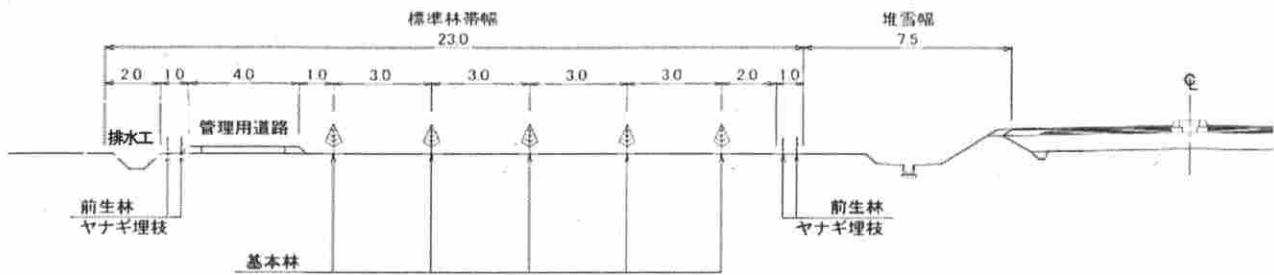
防雪林の標準林植栽標準図の横断面図 (20mタイプの例, 単位 m)
